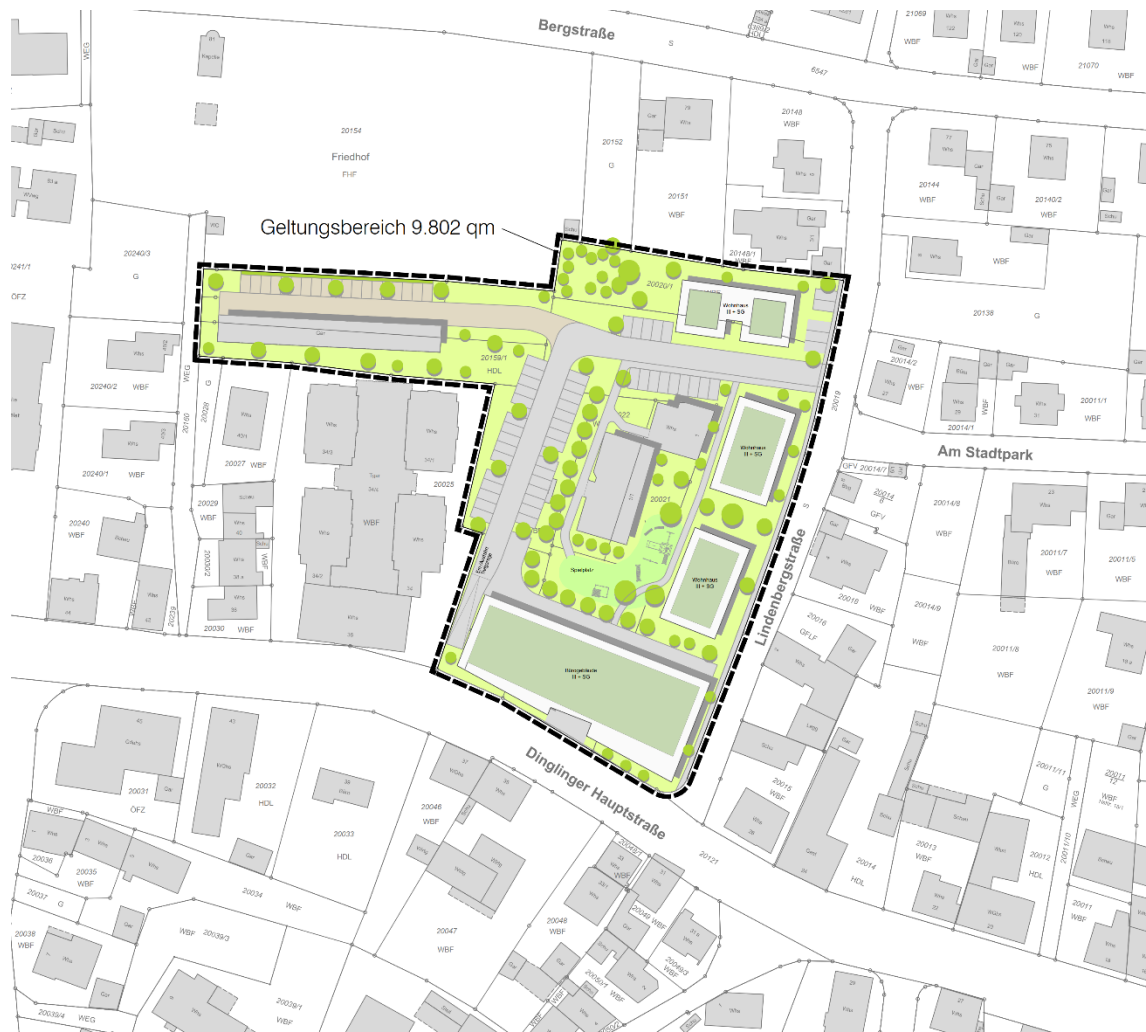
Lageplan, Zink Ingenieure, Lauf vom 06.11.2023
